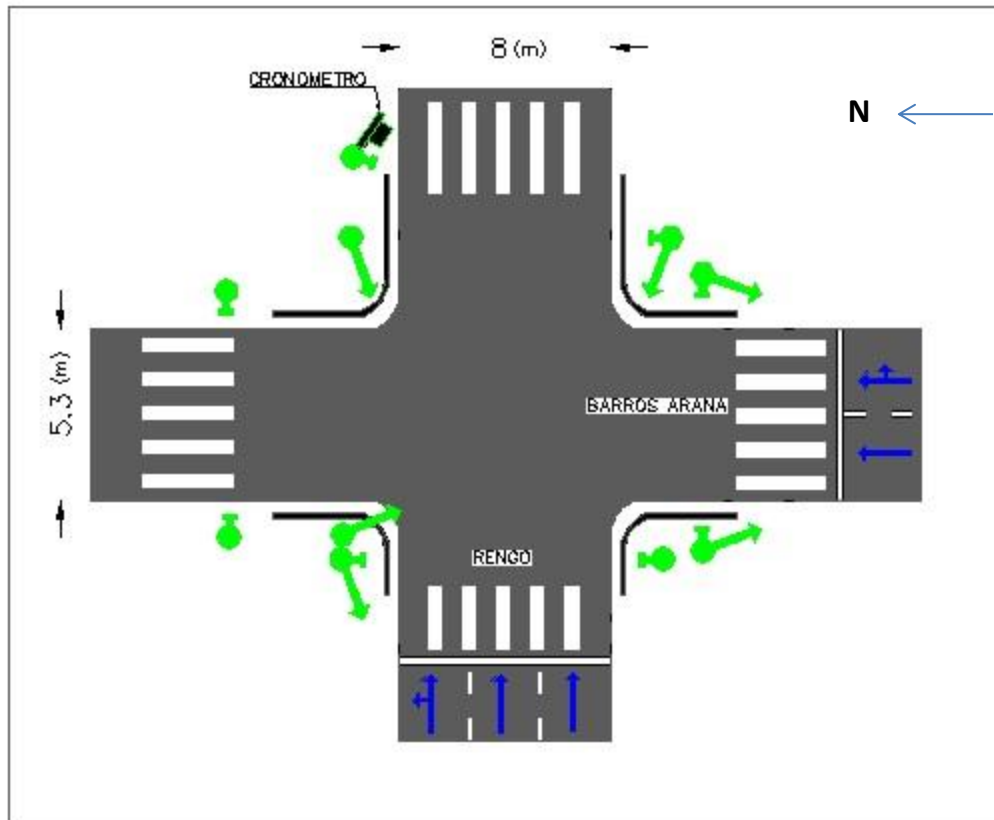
Planta intersección Barros Arana / Rengo
